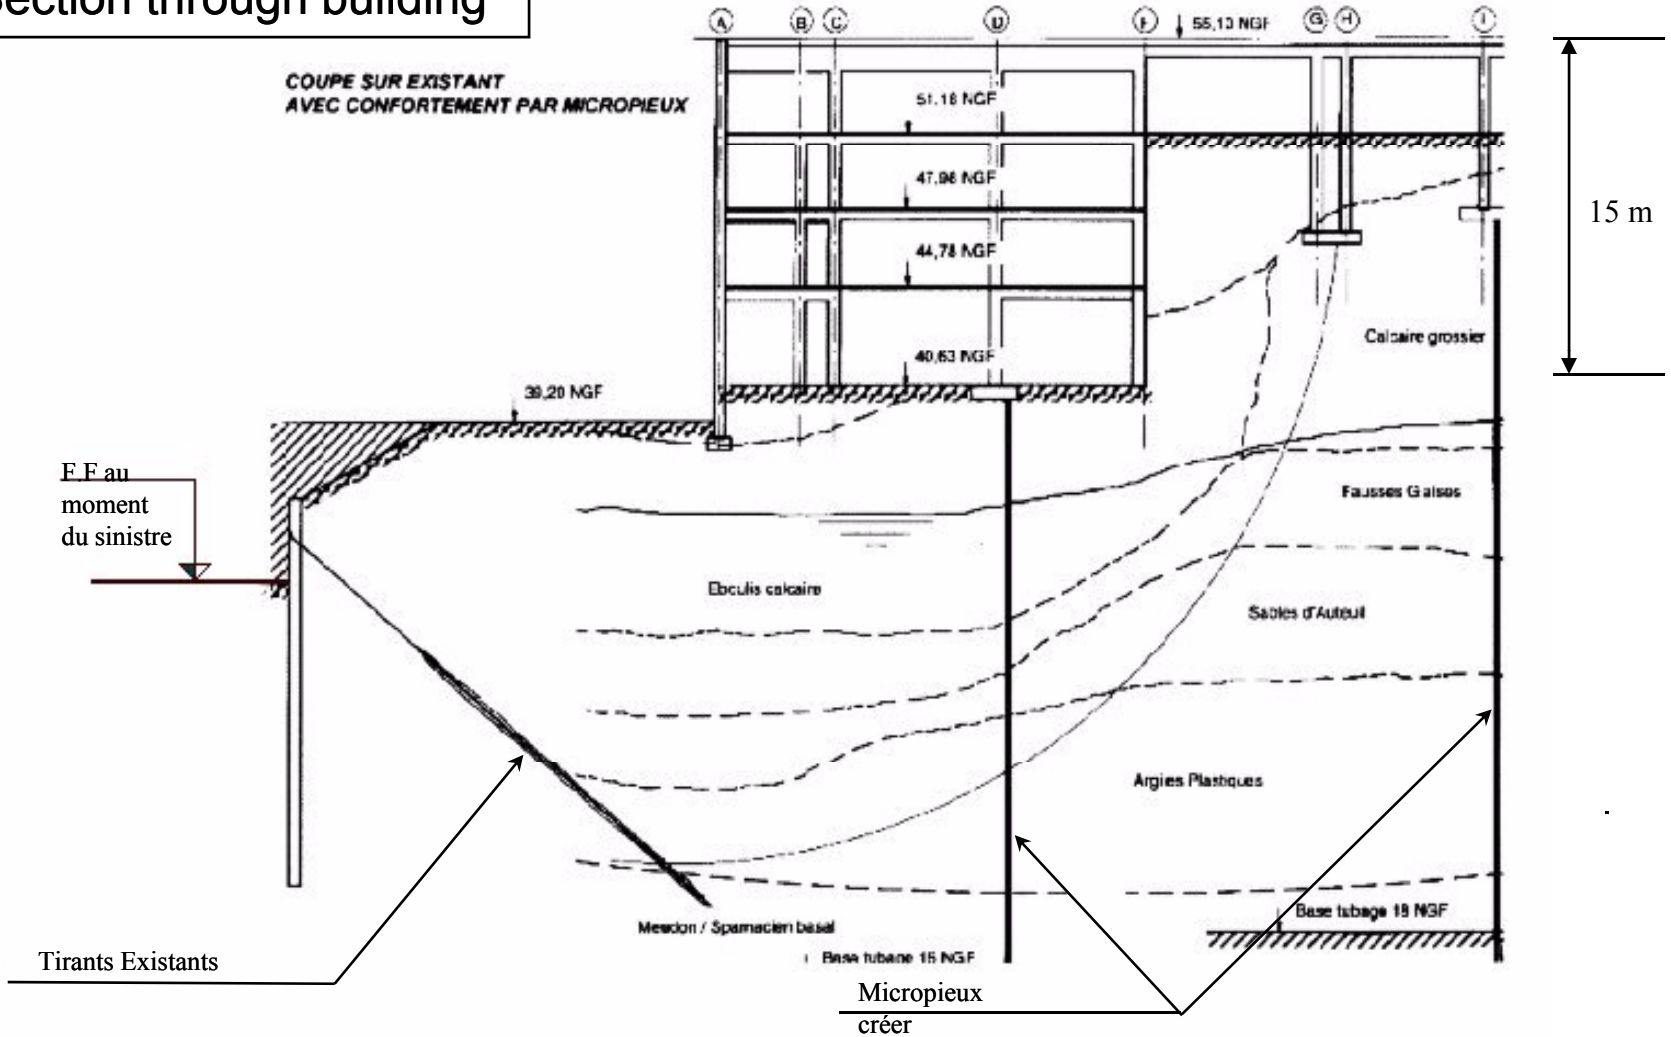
DETAIL AU DROIT DE LA PAROI EXISTANTE APRES SINISTRE
